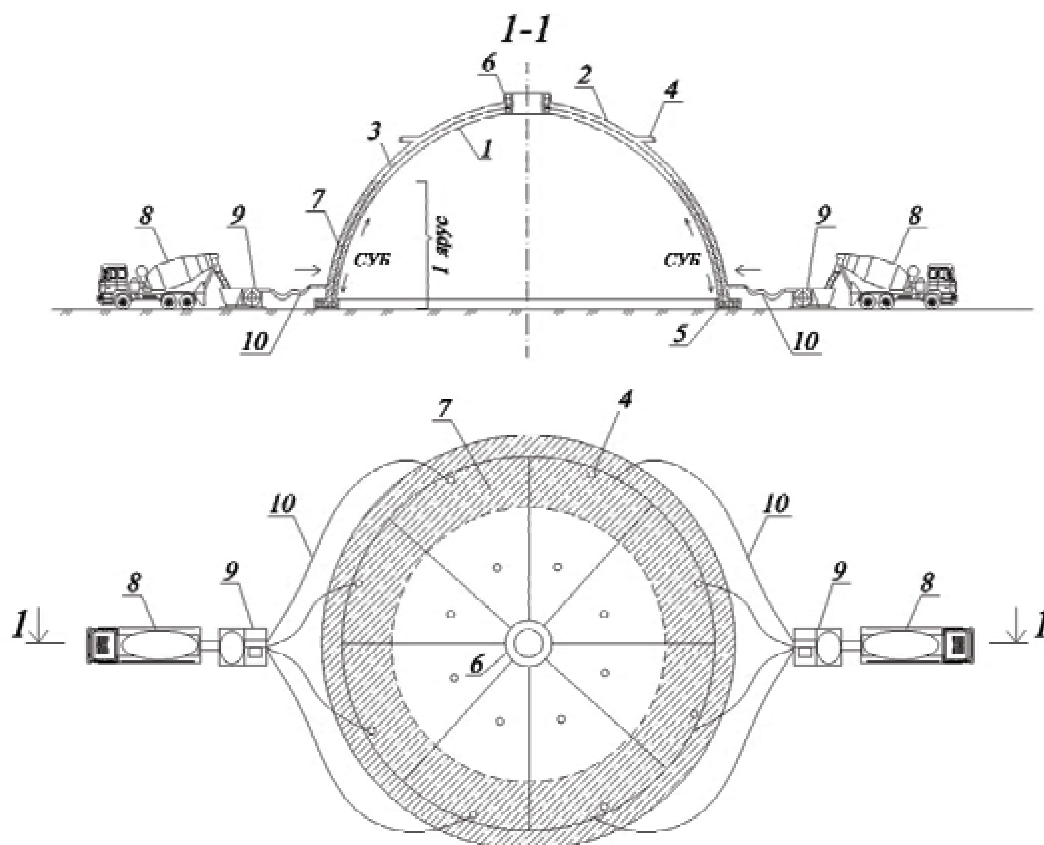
Бетонирование первого яруса купола: 1 – внутренняя опалубка; 2 – наружная опалубка; 3 – арматура купола; 4 – штуцеры для подачи бетона; 5 – нижнее опорное кольцо; 6 – верхнее опорное кольцо; 7 – самоуплотняющийся бетон первого яруса; 8 – автобетоносмеситель; 9 – роторный насос; 10 – шланг.
